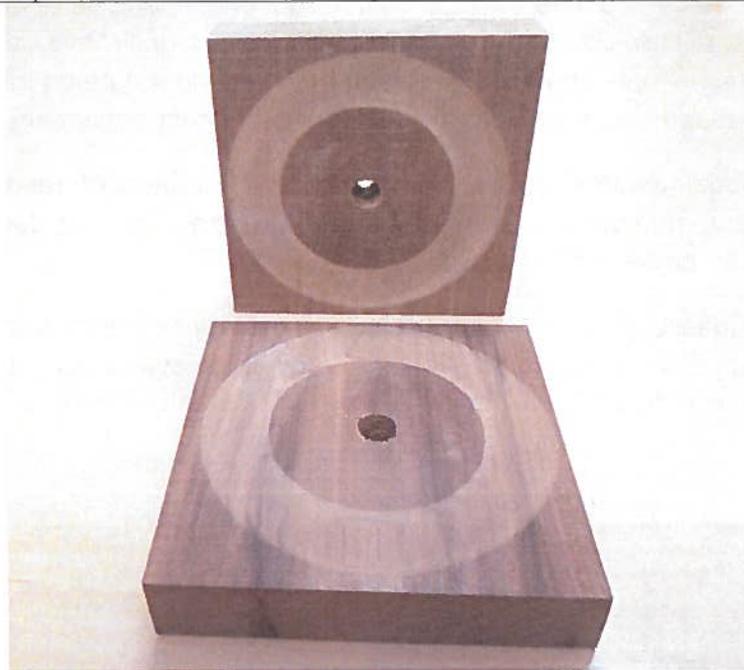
État d'une éprouvette après 500 révolutions de roulette abrasive
